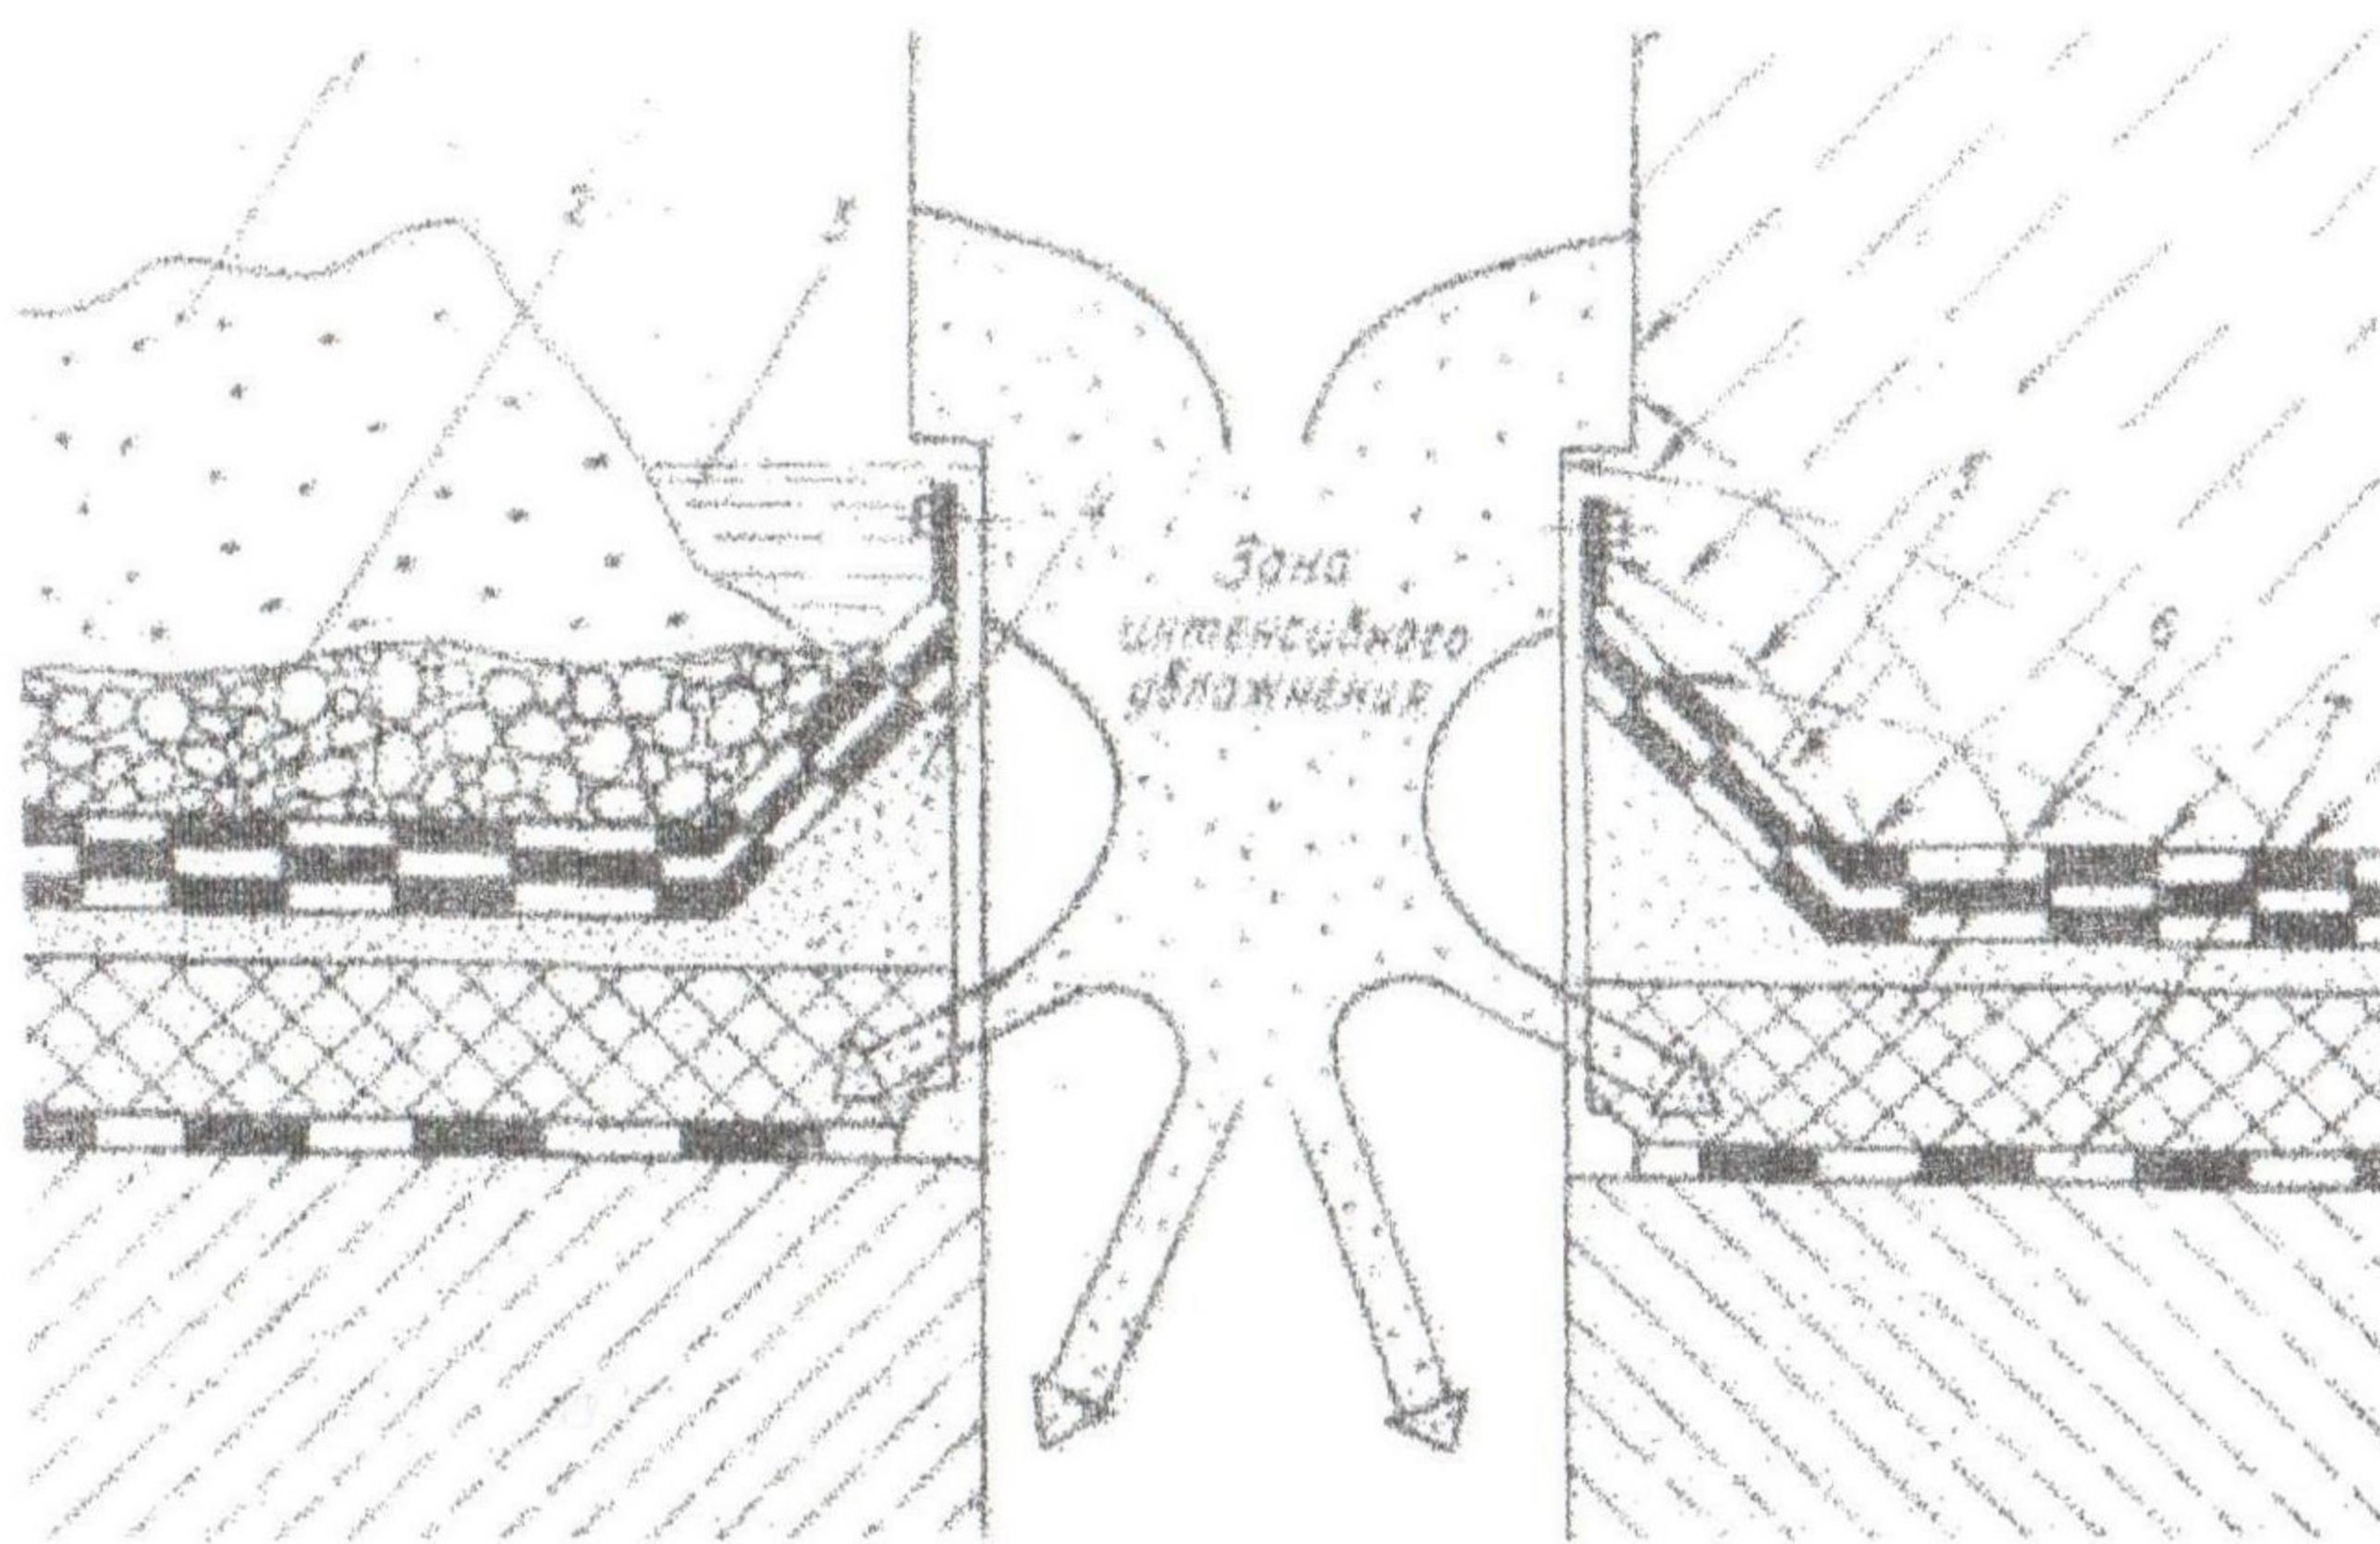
Характерные протечки кровель при нарушении правил, устройства примыканий кровли (занижена высота закрепления кровельного ковра): 1 — скопление снега; 2 — защитная посыпка; 3 — уровень воды; 4—выкружка; 5— кровельный ковер; 6 — утеплитель; 7 — пароизоляция.
